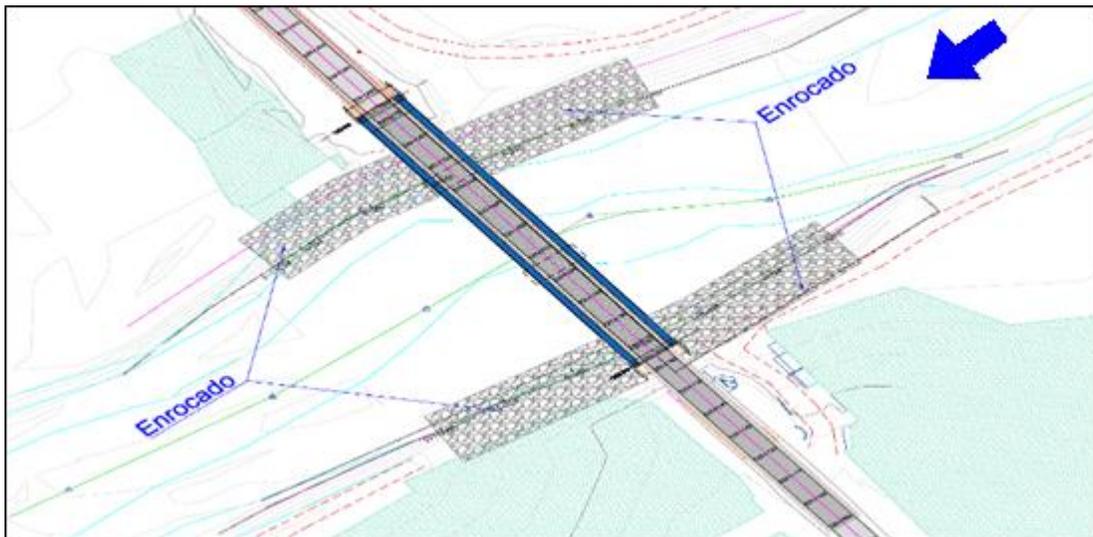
Defensas Ribereñas con Enrocado, vista de Planta.
